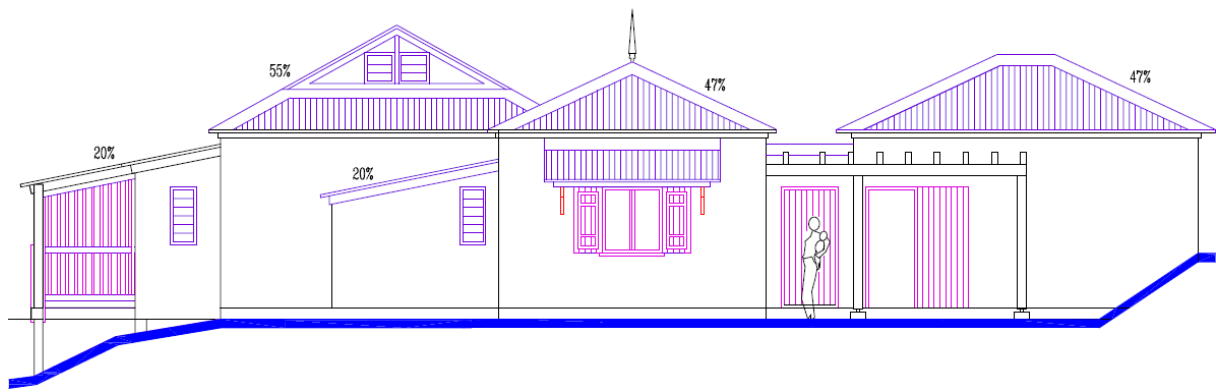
pilotis et vide sanitaire, détail d'une façade en Z3 Ouest
